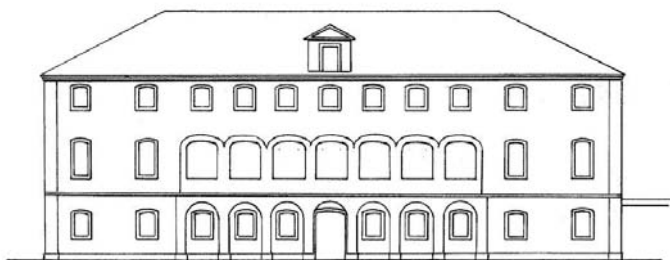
Reconstrucción conjetural de la fachada norte de la Casa del Comandante General. Dibujo de Vicente Vigo.
